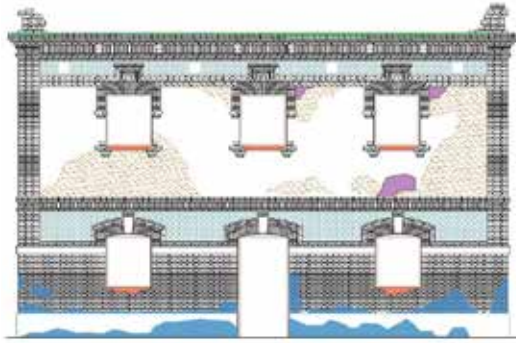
Patologías existentes en fachada sur de Los Baños.
